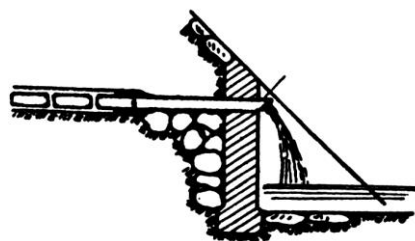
Gură de evacuare deschisă direct cu tub de beton sau fontă sprijinită pe zid.
